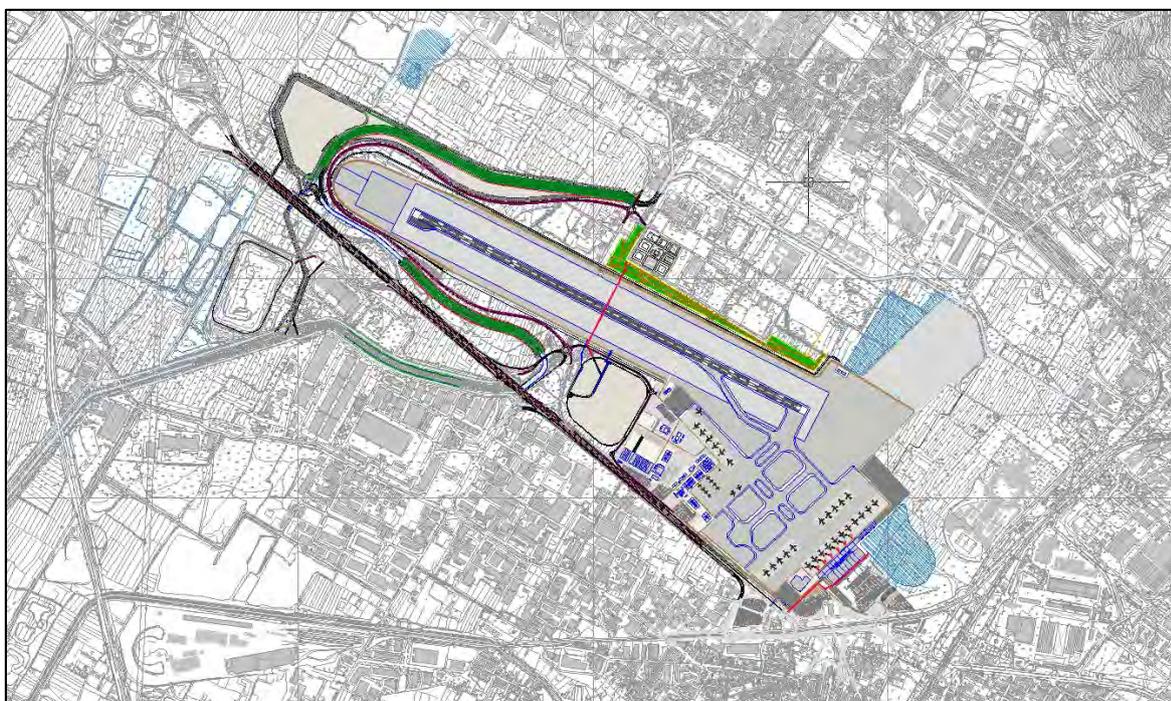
stralcio della planimetria di progetto dell'Aeroporto "Amerigo Vespucci"
